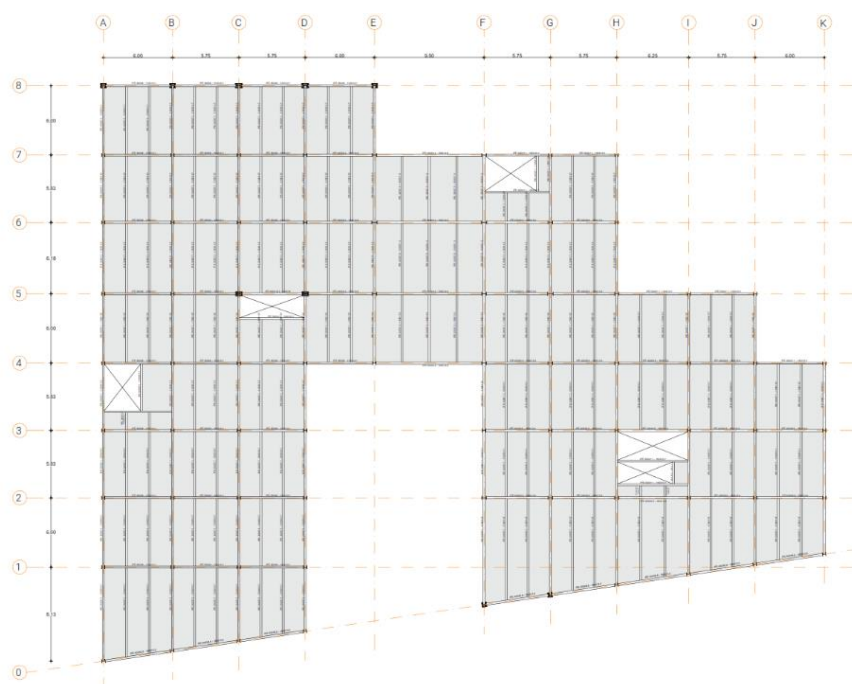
Sistema de entrespiso primera planta alta (Gualavisí N., 2022)
